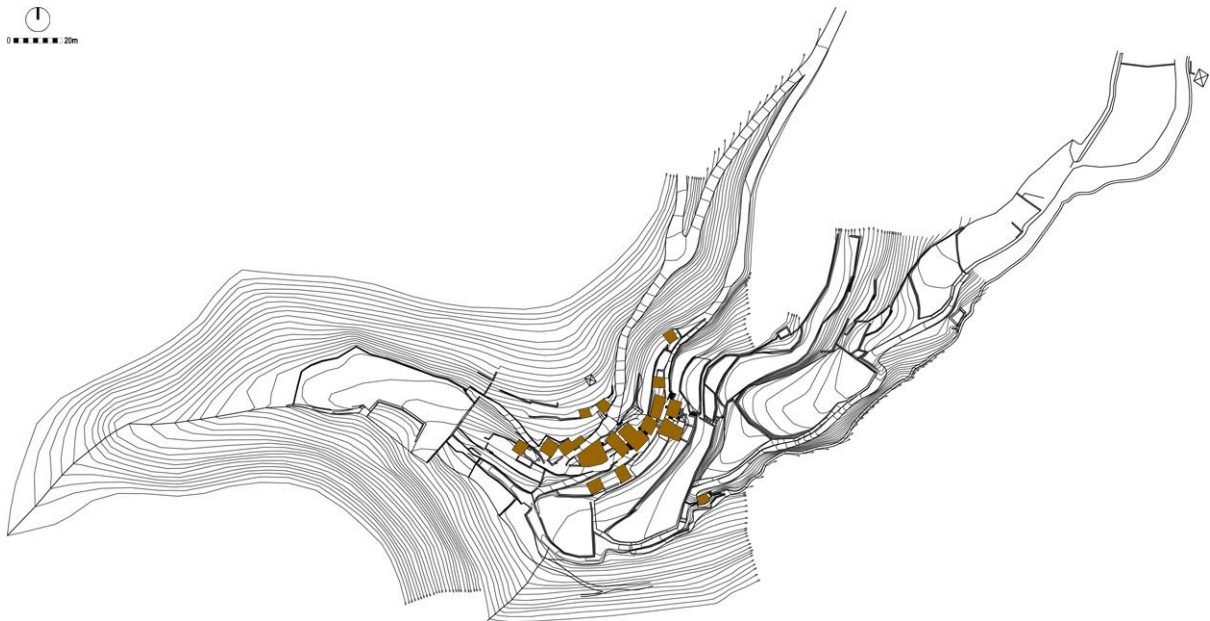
Levantamento topográfico da aldeia e localização do conjunto edificado (Fonte: PuraPoesia . arquitectura, planeamento & design)
